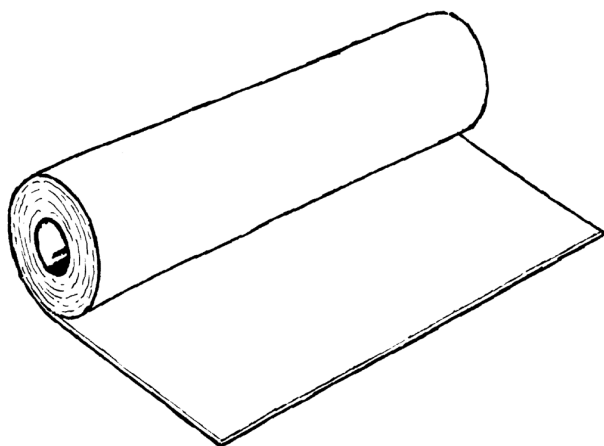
Timberlit anvendes til plane undergulve af beton, krydsfiner, spånplade og lignende. Udrullet Timberlit er 2 mm tykt.
